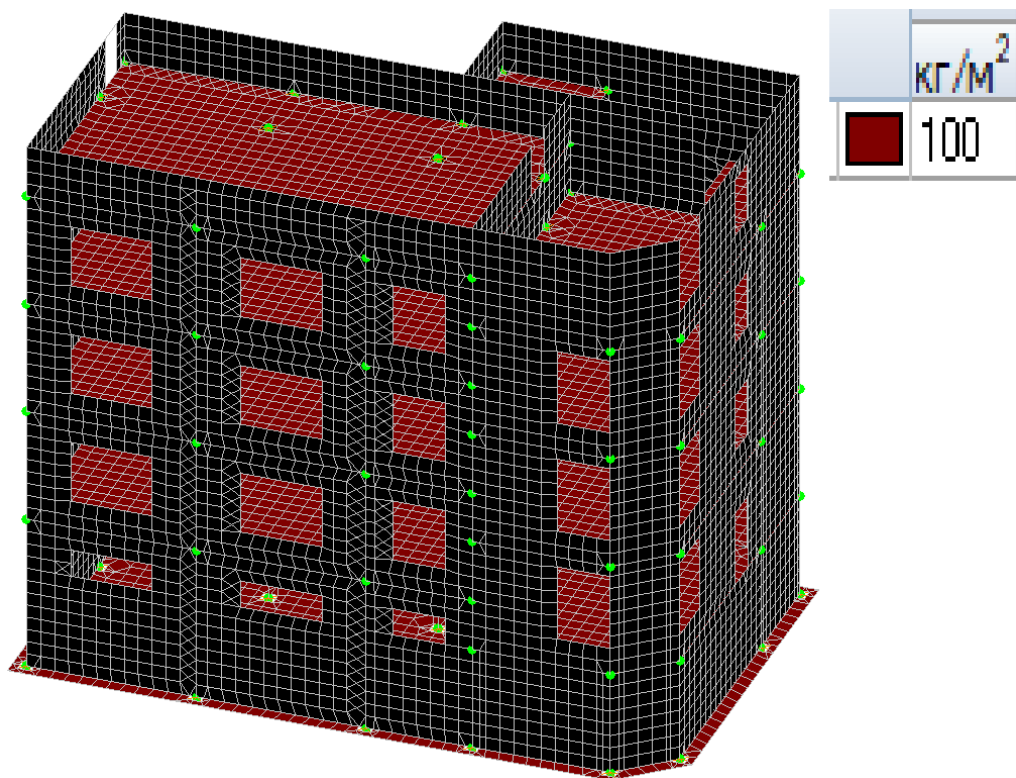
Схема приложения нагрузок от перегородок
